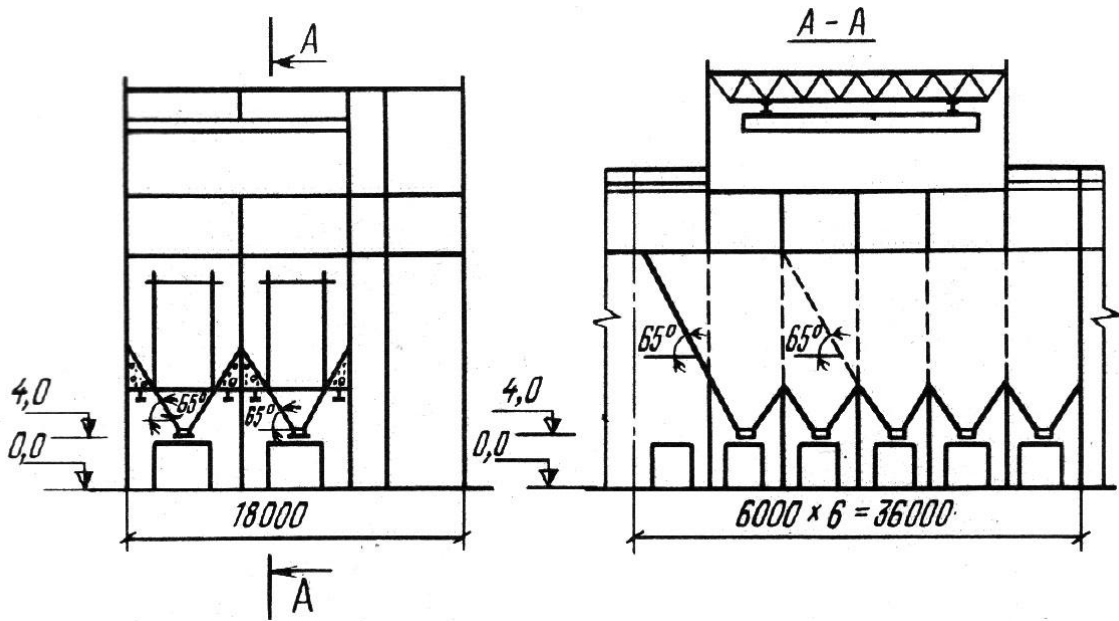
Габаритная схема унифицированной блок-секции аккумулирующего прямоугольного бункера с наклонными стенками для угля
